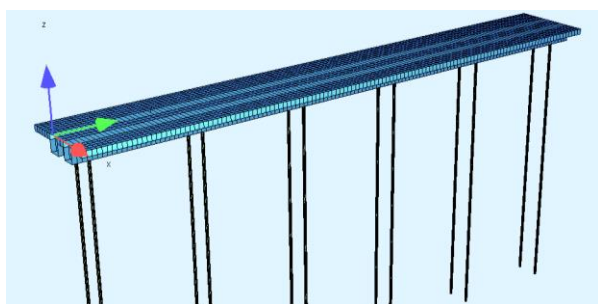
Modelo 3D estructura voladizo losa 1.5 m
